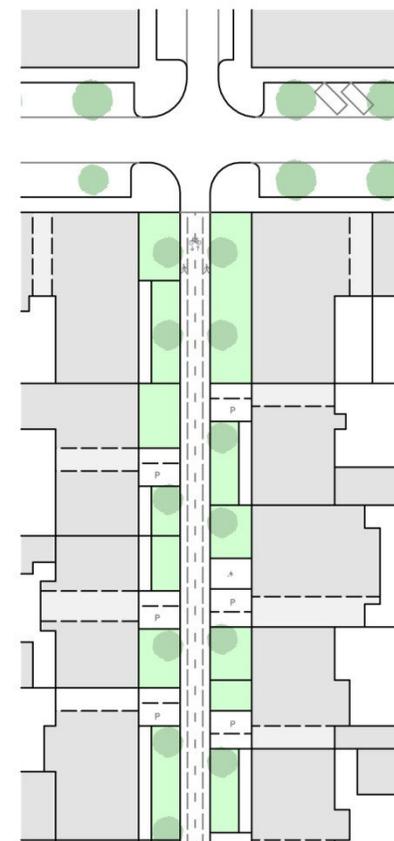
Umbauvarianten Nebenstraßen M 1:1000
